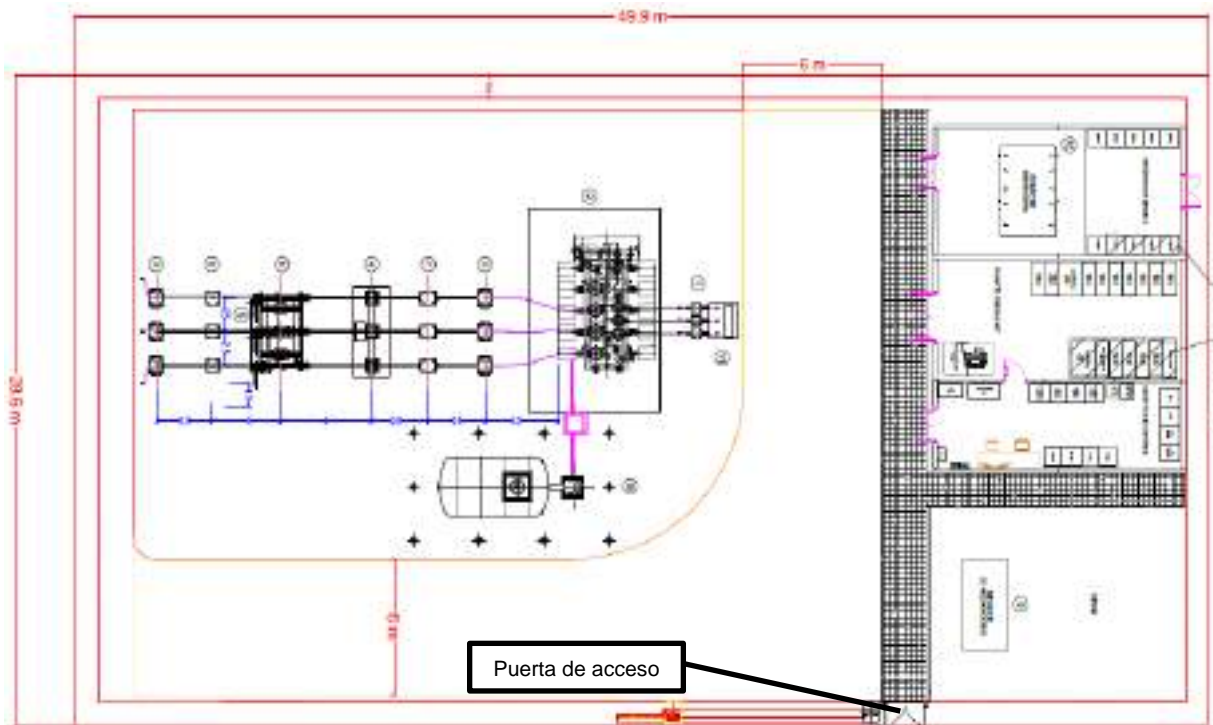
Puerta de Acceso a la Subestación Elevadora.
